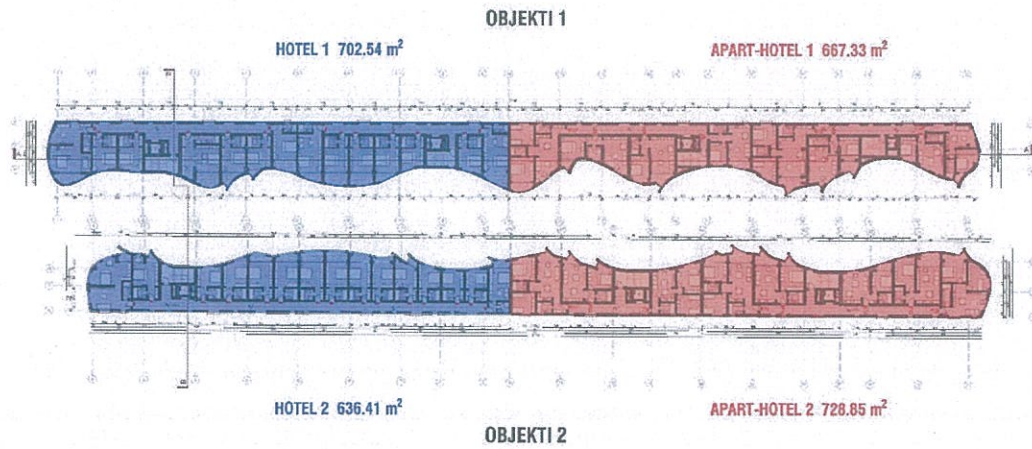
Planimetria e Katit të Parë \_HOTEL DHE APART - HOTEL
